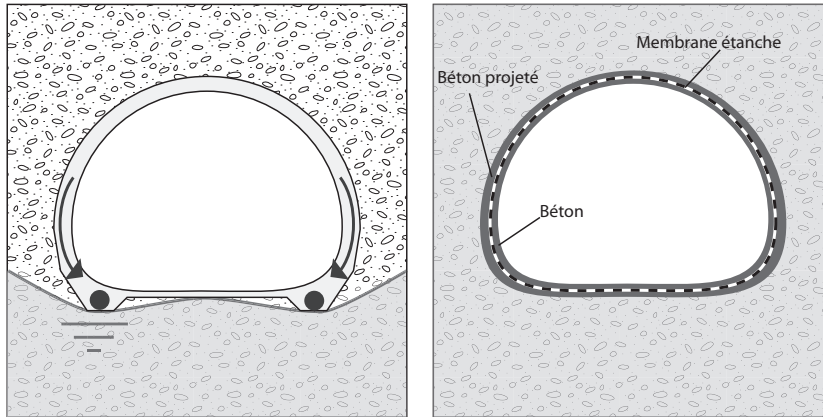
Tunnel construit en nappe de manière drainante ou étanche
